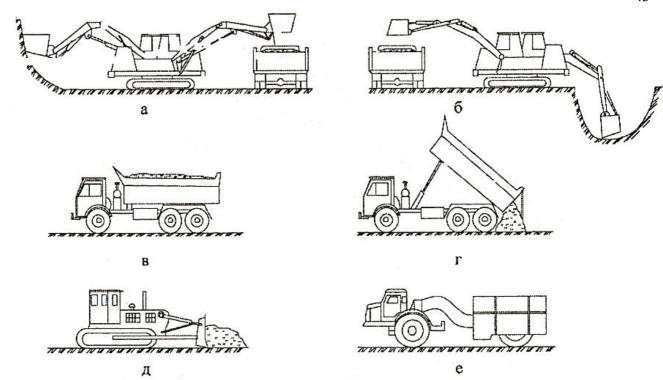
Схема комплексной механизации земляных работ при разработке грунта экскаватором: а — разработка грунта экскаватором (прямая лопата) с погрузкой в транспортное средство; б — то же (обратная лопата); в — транспортирование грунта; г — разгрузка; д — разравнивание грунта бульдозером; е — уплотнение грунта катком
